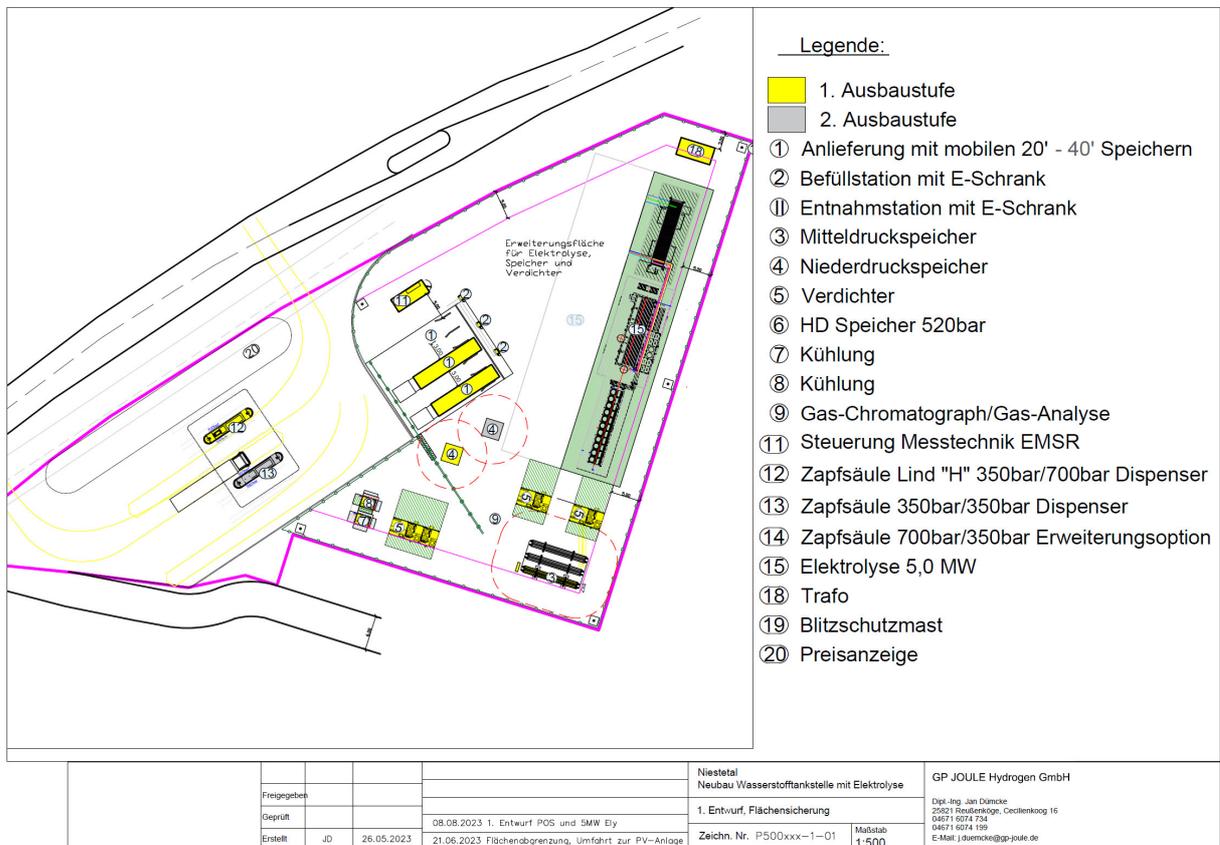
Lageplan der geplanten Wasserstoffproduktion mit Anlagenverteilung
